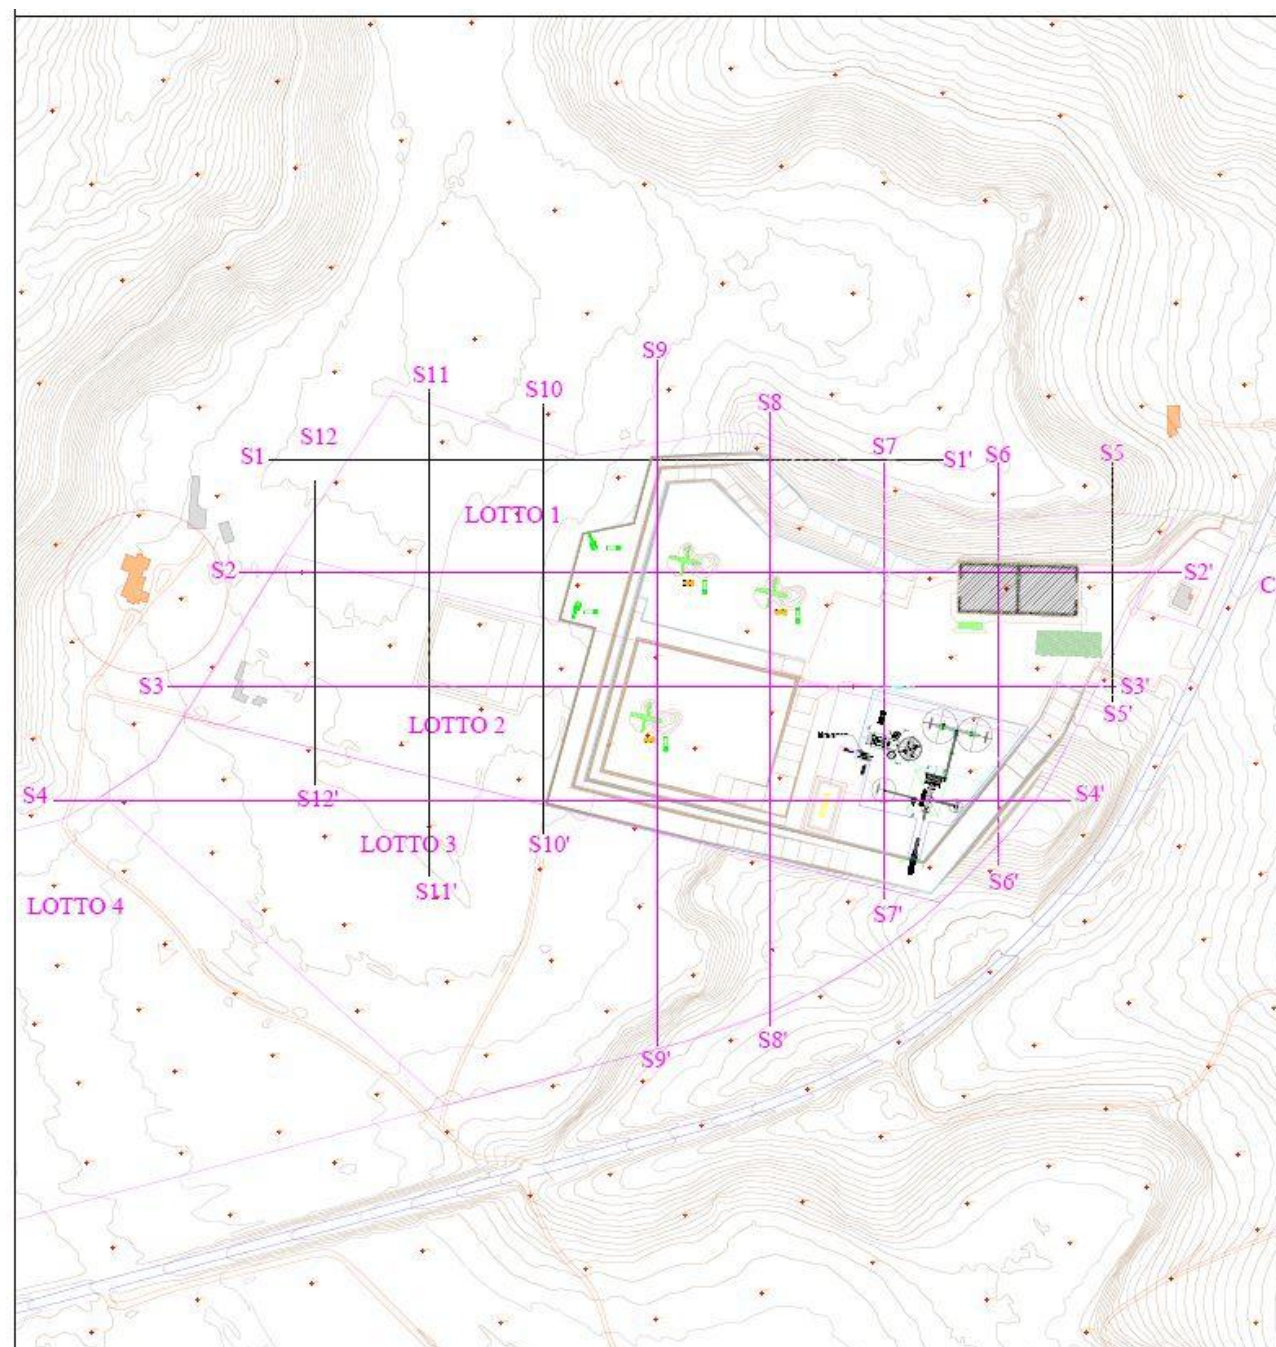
/A – Planimetria stato di progetto con indicazioni delle sezioni
